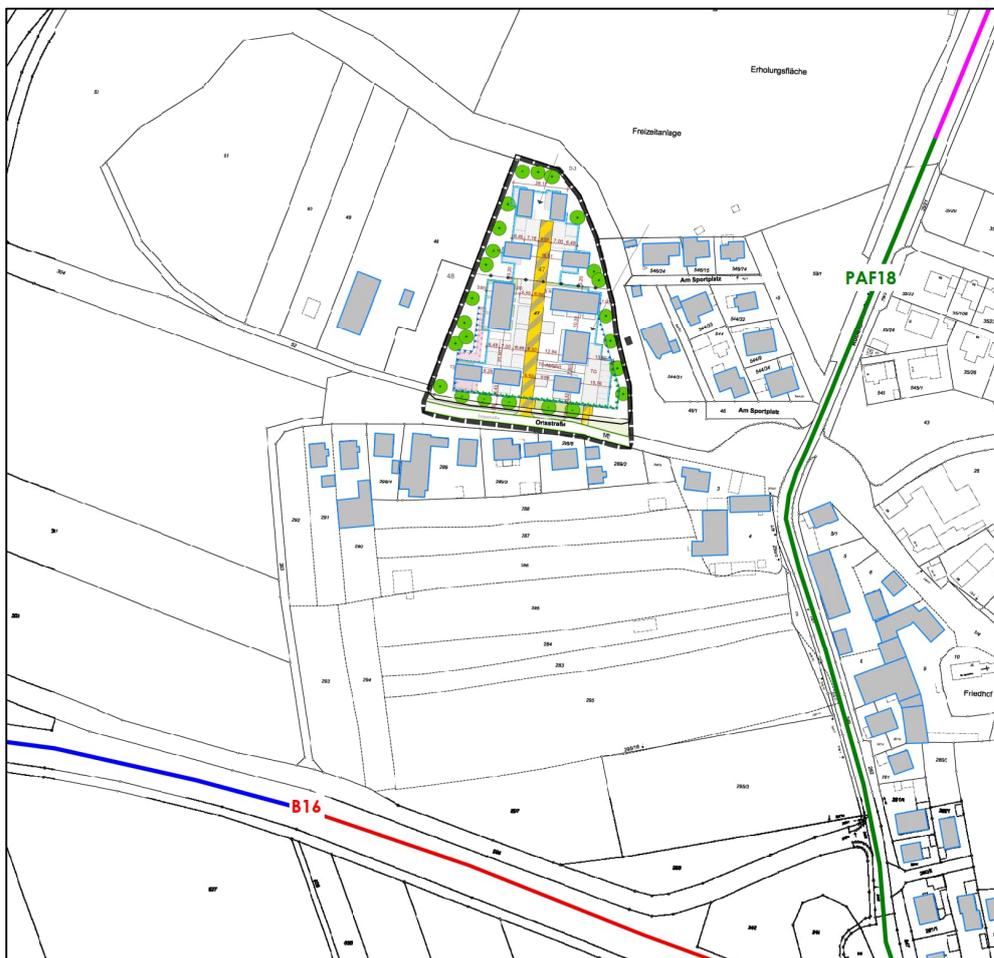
Lageplan mit Darstellung der betrachteten Straßenabschnitte
